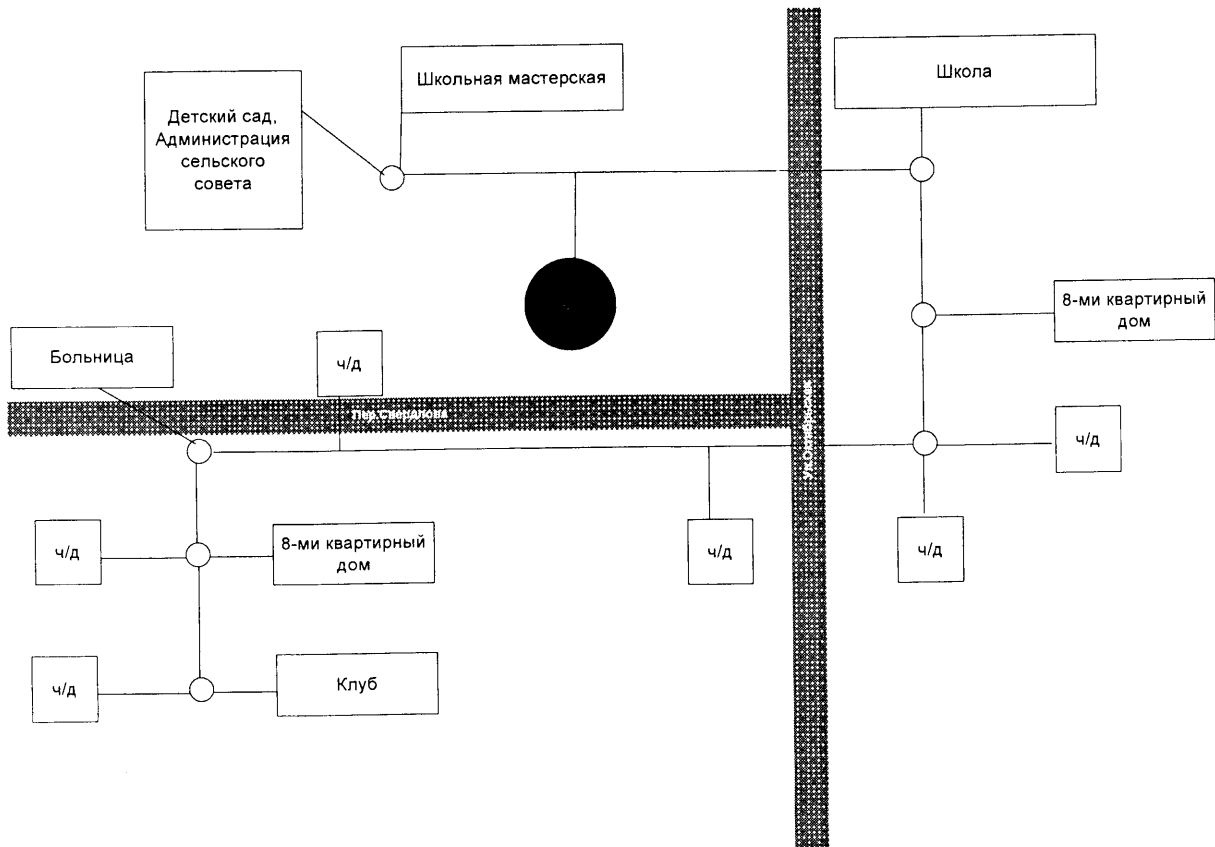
Схема размещения тепловых сетей от котельной с.Усть-Миасское
